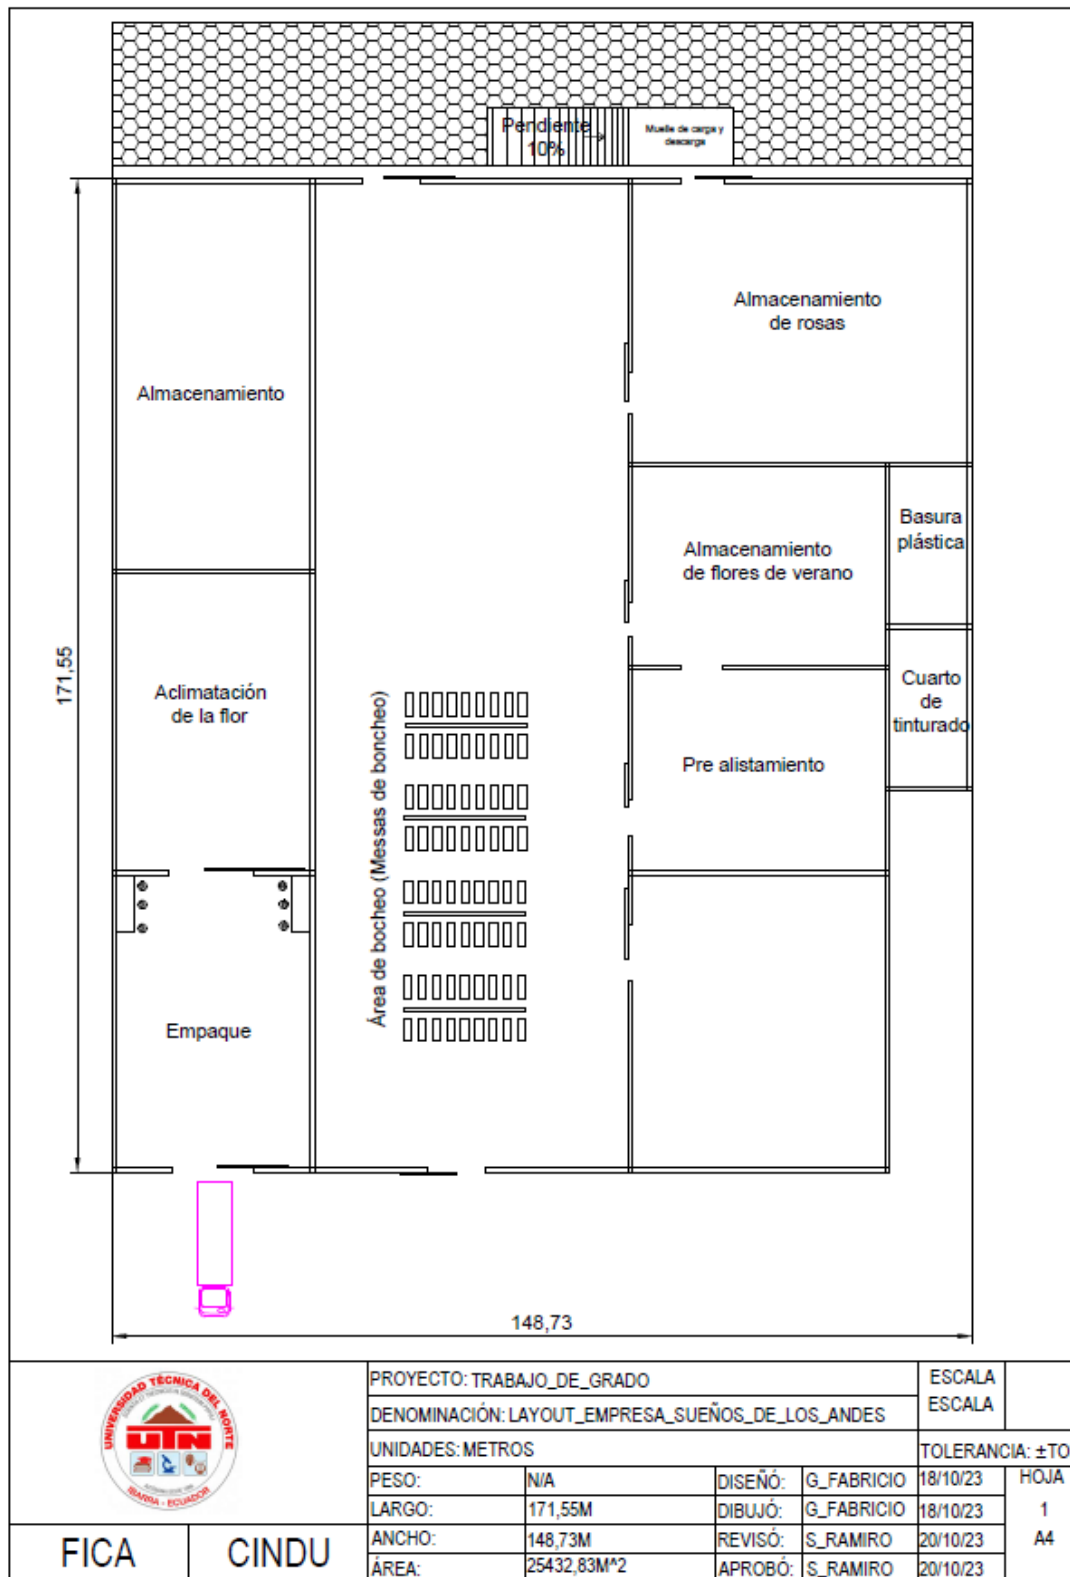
Distribución de la planta de la empresa Sueño de los Andes Bouquetandes S.A.
